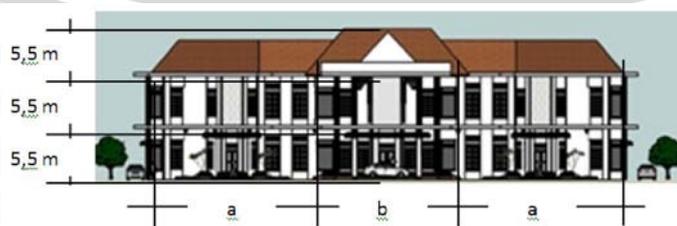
Dinding, kolom dan perbedaan lantai pada alternatif 1
